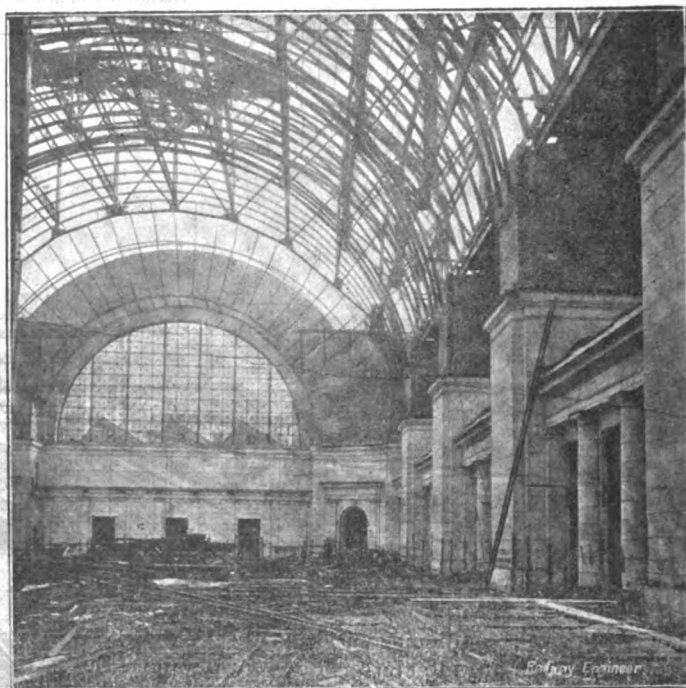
Stazione ferroviaria di Washington. - Sala d'aspetto in costruzione.
